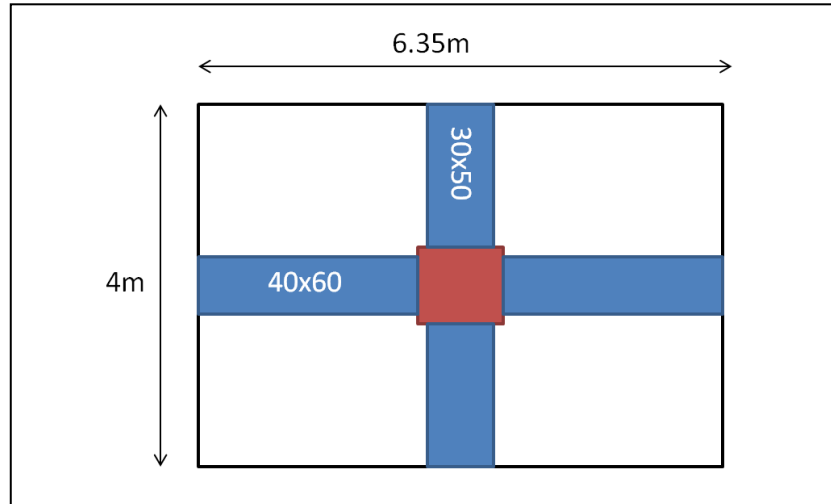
Surface du plancher reprise par le poteau le plus sollicité
